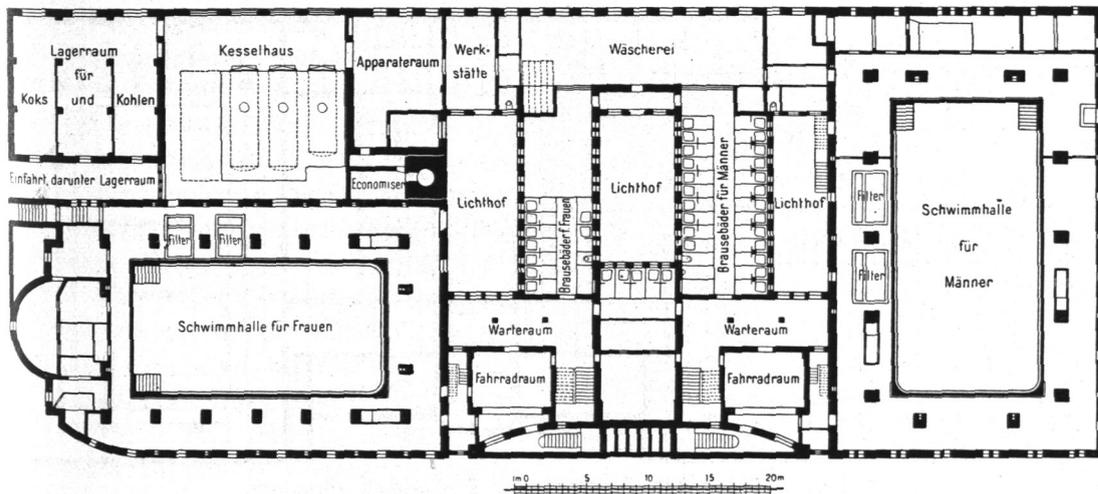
Badeanstalt Hammerbrook, Kellergeschoß, Grundriß.
